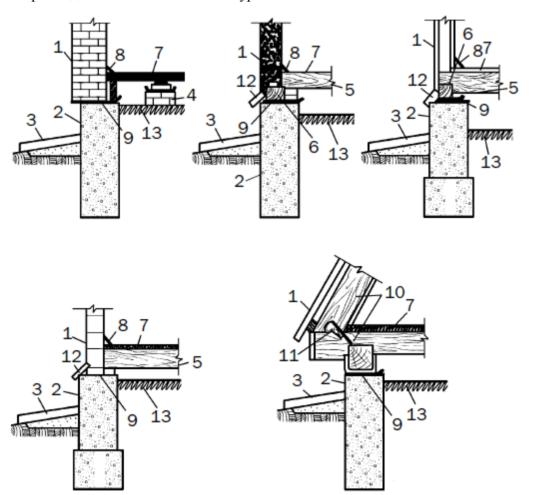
Устройство цоколя под стены: а – кирпичные; б – деревянные щитовые; в – каркасные; г – бревенчатые (брусчатые); 1 – стена; 2 – фундамент; 3 – отмостка; 4 – кирпичный столбик; 5 – балка перекрытия; 6 – брус нижней обвязки; 7 – пол; 8 – плинтус; 9 – слой гидроизоляции; 10 – рама; 11 – анкер; 12 – отливная доска; 13 – грунт
